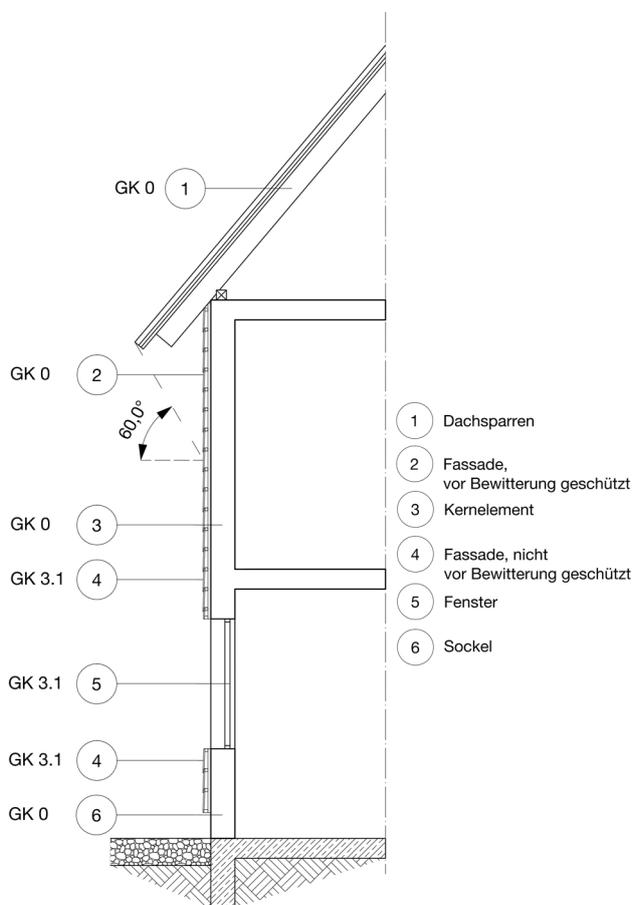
Zuordnung von Holzbauteilen bzw. Systembereiche des Fassadenelements zu einer Gebrauchsklasse (Eigene Darstellung)
